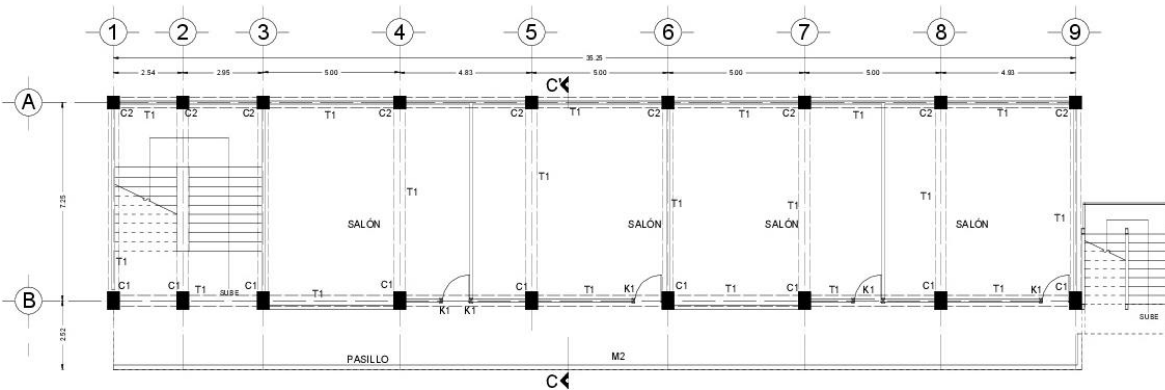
Croquis de dimensiones y elementos en planta del N3. (GACONSA, 2018)
